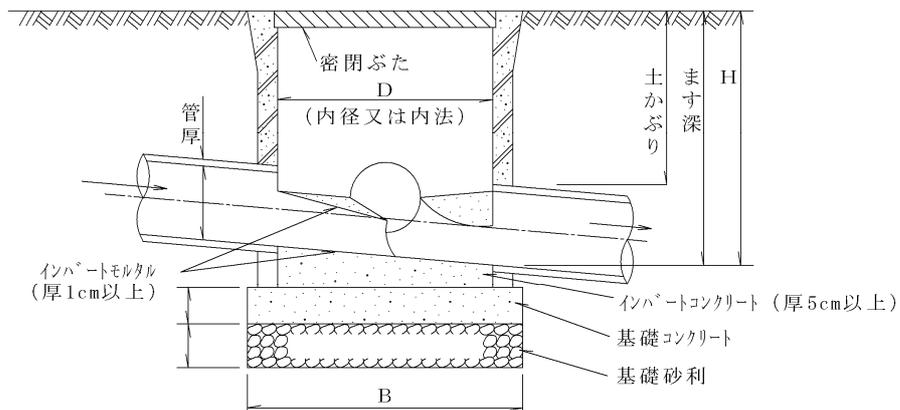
鉄筋コンクリート製のますの例（一部現場施工、既製ブロック使用）
